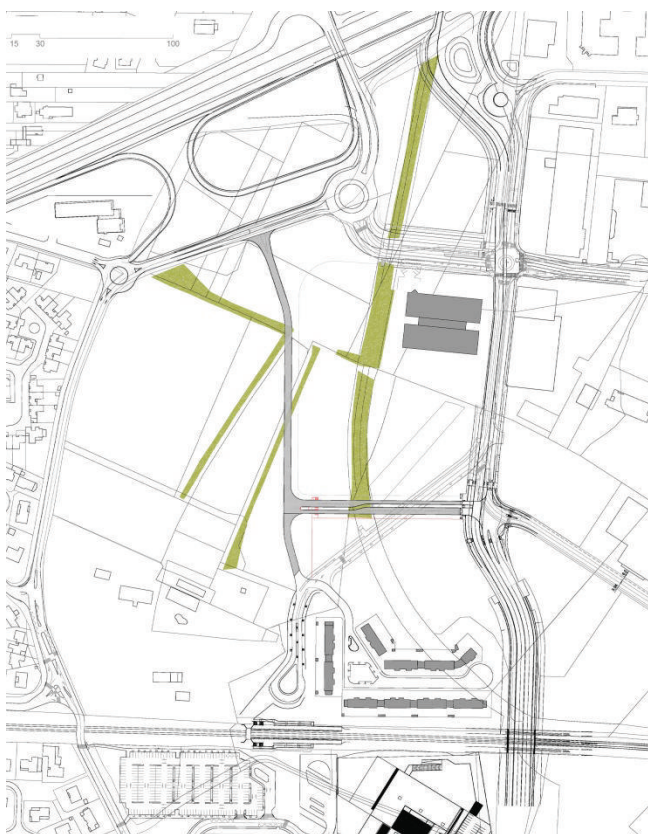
Plan masse du secteur Ramassiers – Source : Pro des espaces publics
